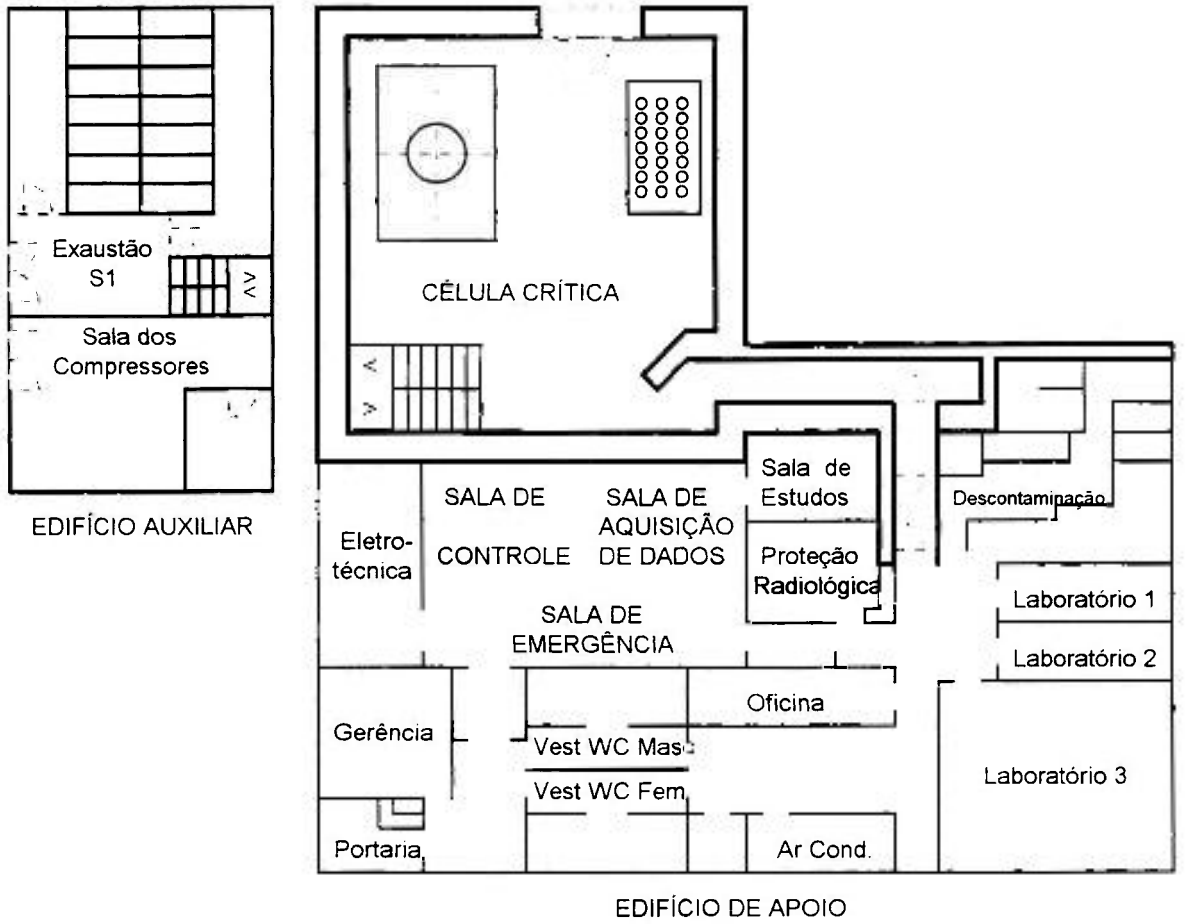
Desenho da planta do reator IPEN/MB-01.
